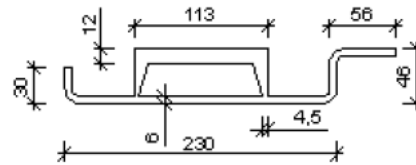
Secção transversal perfil vertical de canto (DCP) [13]
